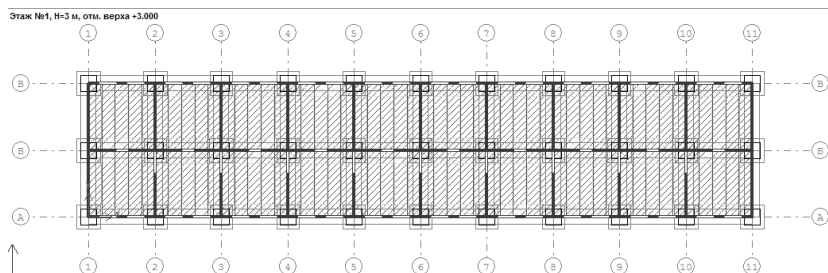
План типового этажа схемы созданной в ПК «МОНОМАХ»
